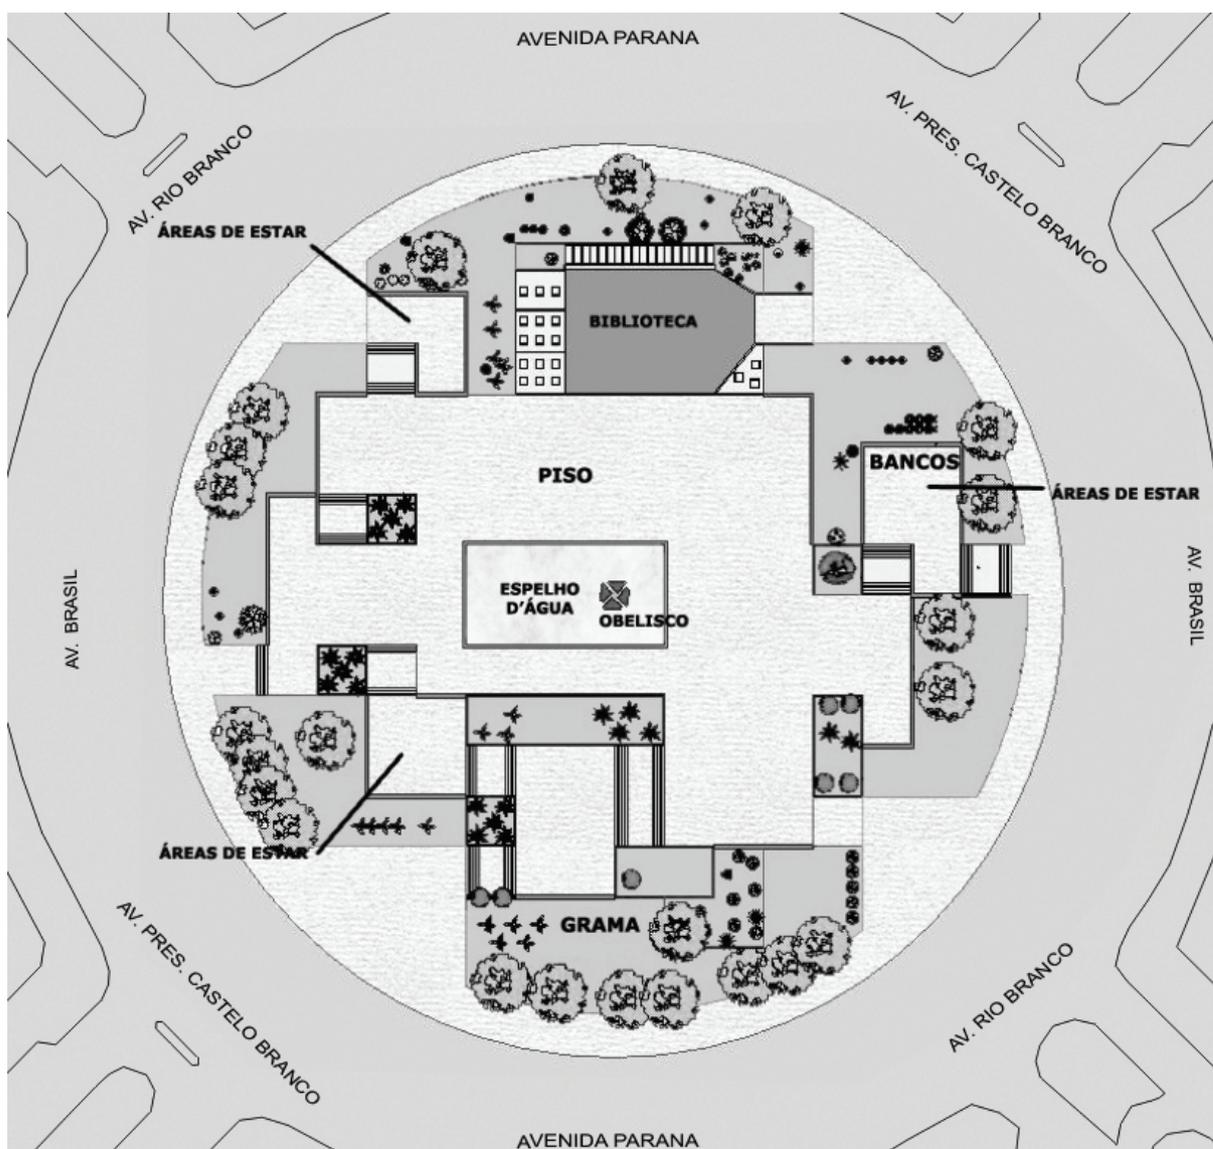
Planta artística da Praça Santos Dumont, s/ escala.
